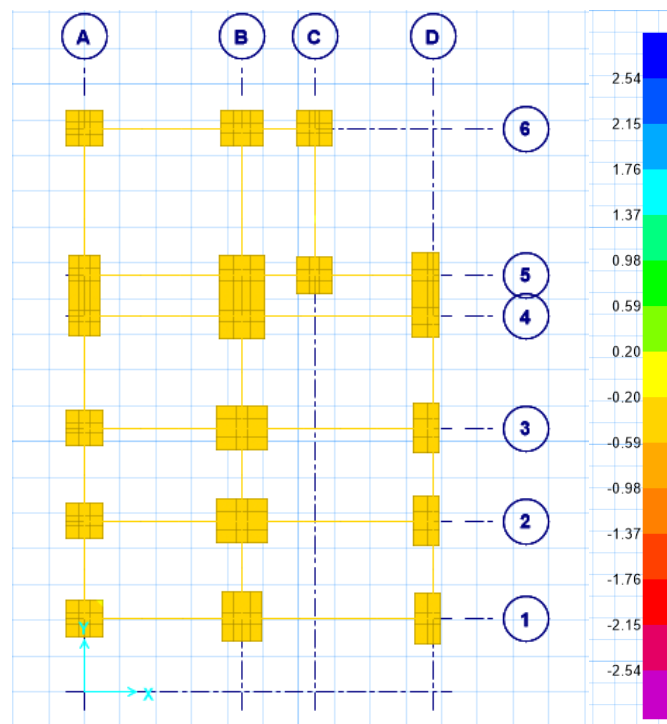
Visualización de las secciones de viga de cimentación, para escenario n°3
